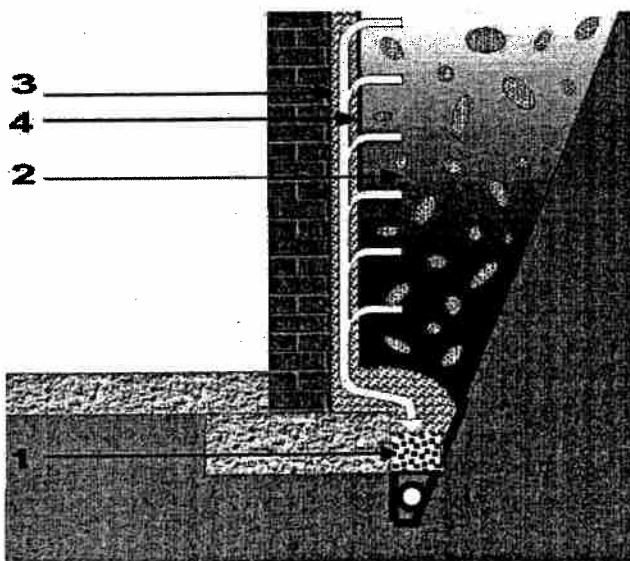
Principe d'un système drainant placé le long d'une construction enterrée
